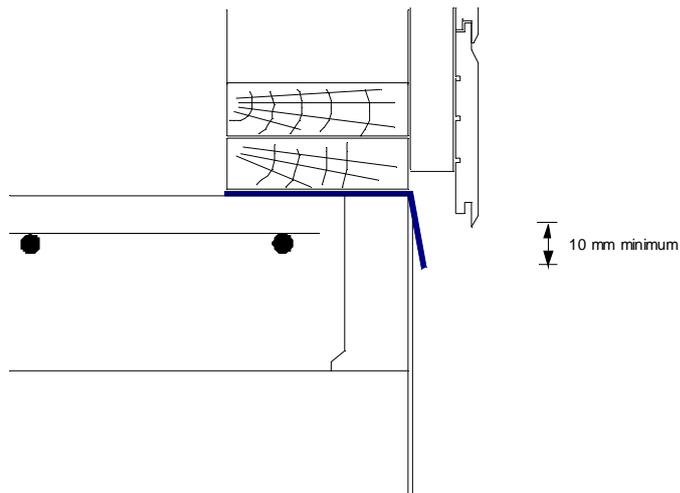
Détail du retour extérieur concerne les constructions à ossature bois
